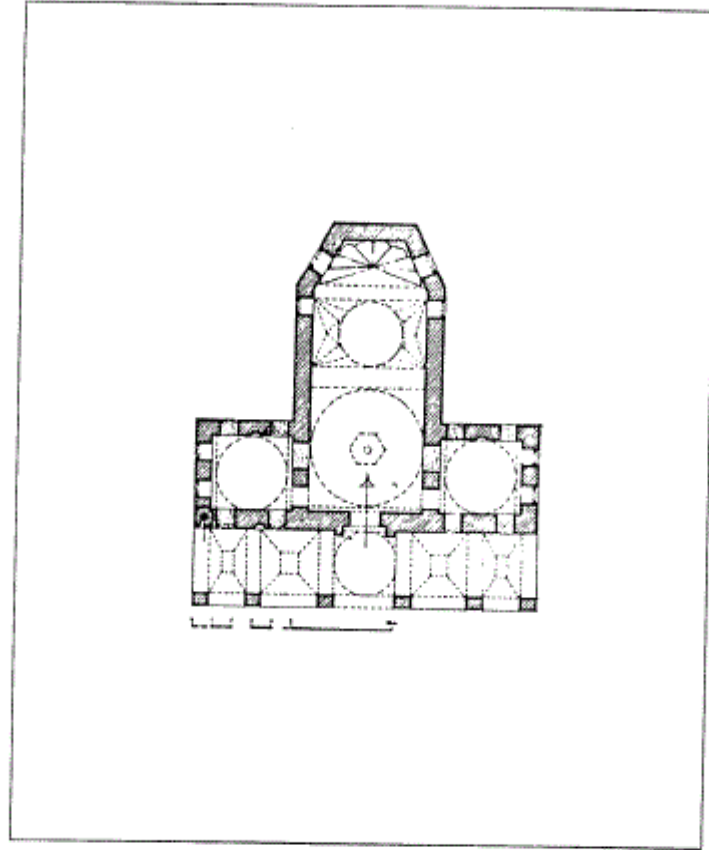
مسقط أفقي للمسجد الكبير في البستان (عن : اصلان ابا)
